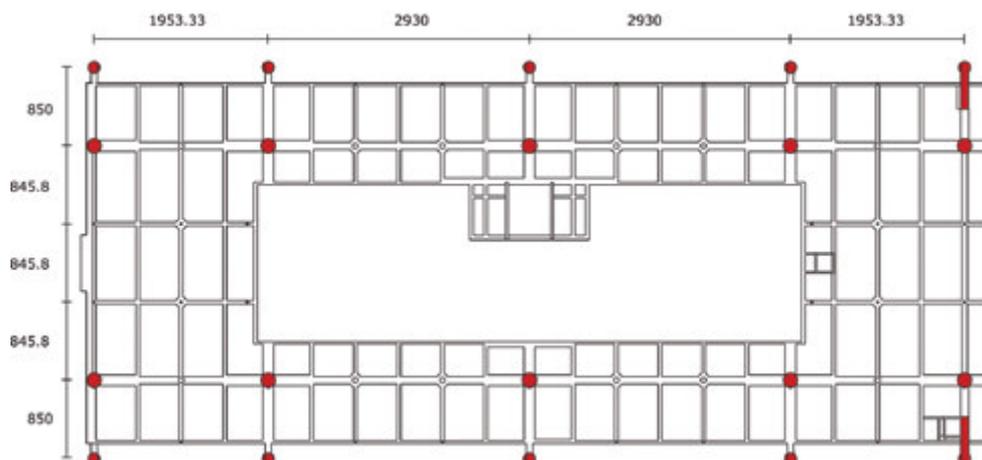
Planta do Segundo Piso do Terminal Sacomã, com Indicação de Pilares e Tirantes.
